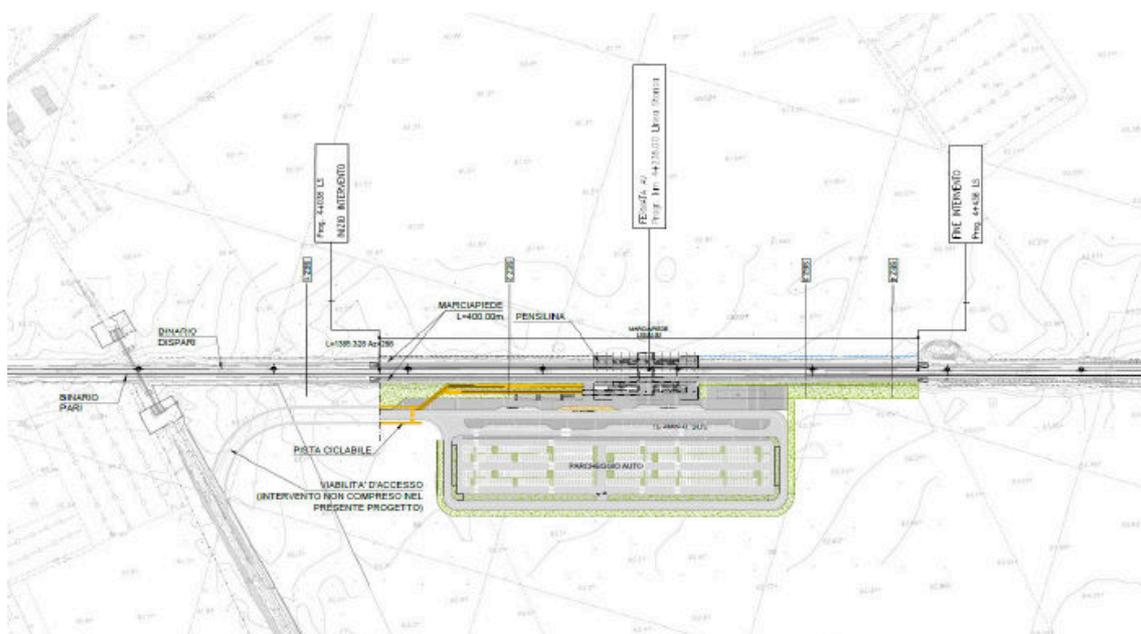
Planimetria di progetto (Fonte: allegato alla Lista di controllo)
